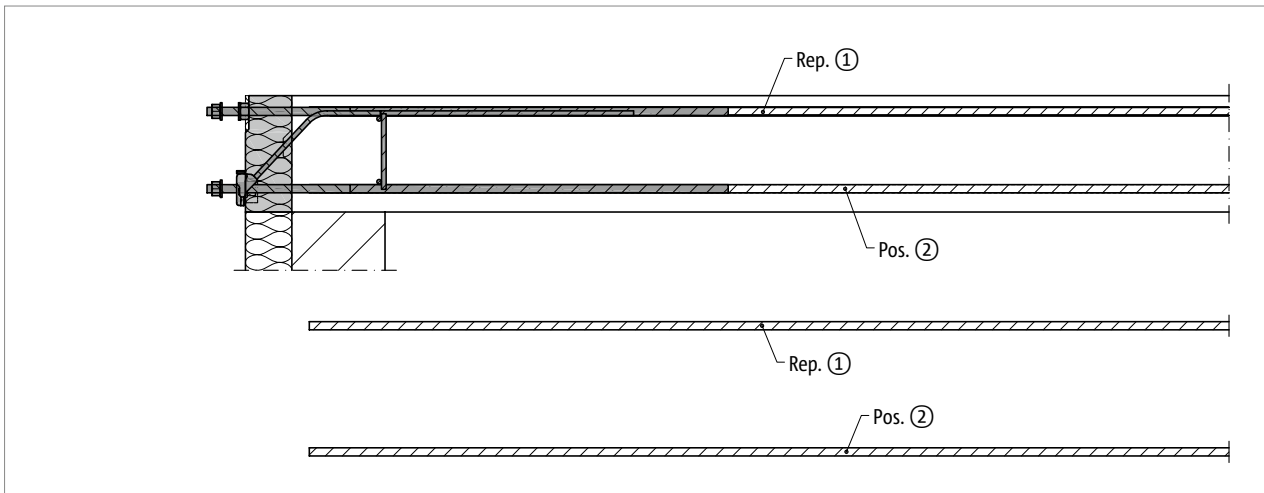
Schöck Isokorb® T type SK-MM1 : renforcement sur site, coupe
